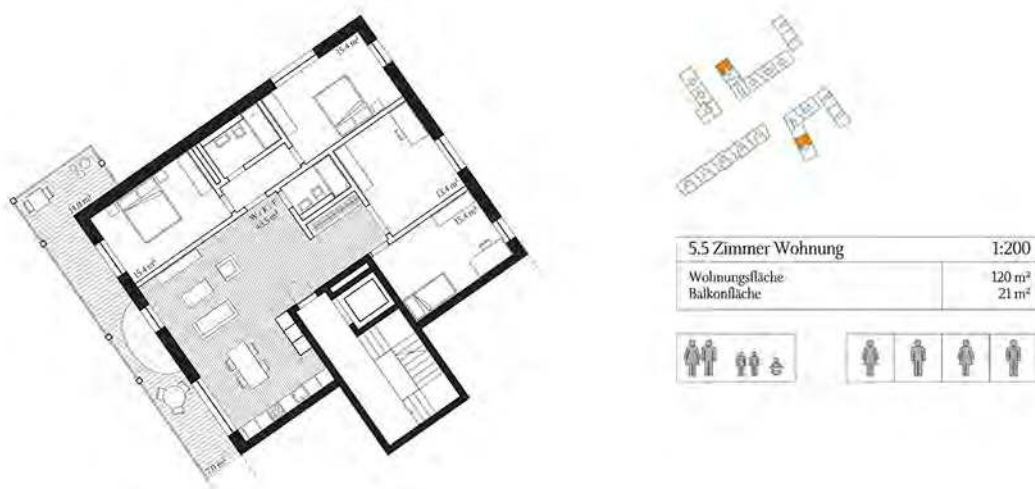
Borough: Wohnungsgrundriss 5.5-Zimmer-Whg.
